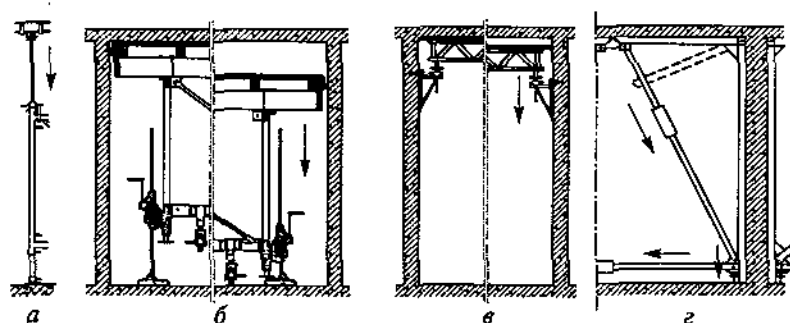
Способы снятия опалубки перекрытий с помощью:
